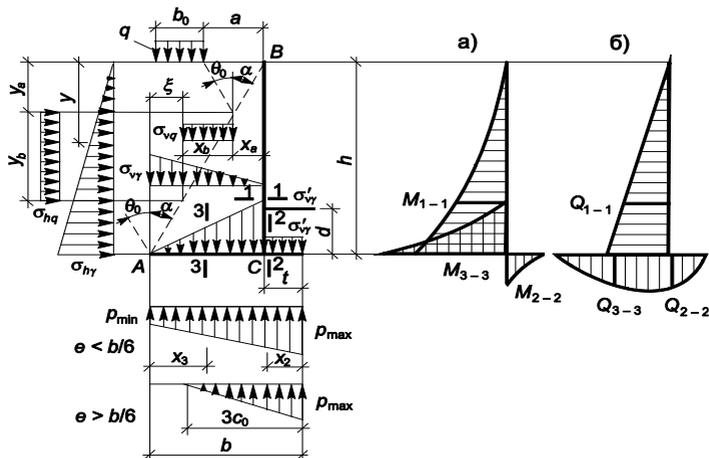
Расчетная схема подпорной стены уголкового типа при расчете ее на прочность:
